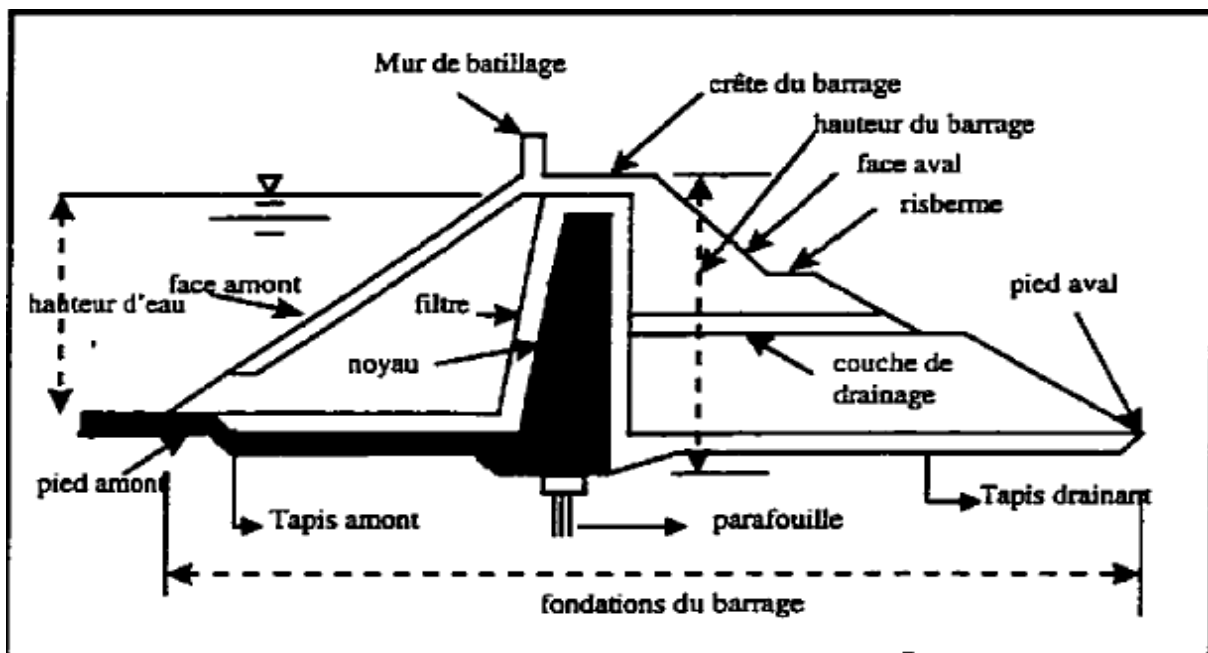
Coupe transversale d'un barrage en remblai (BOUSSAAD, 1998)
